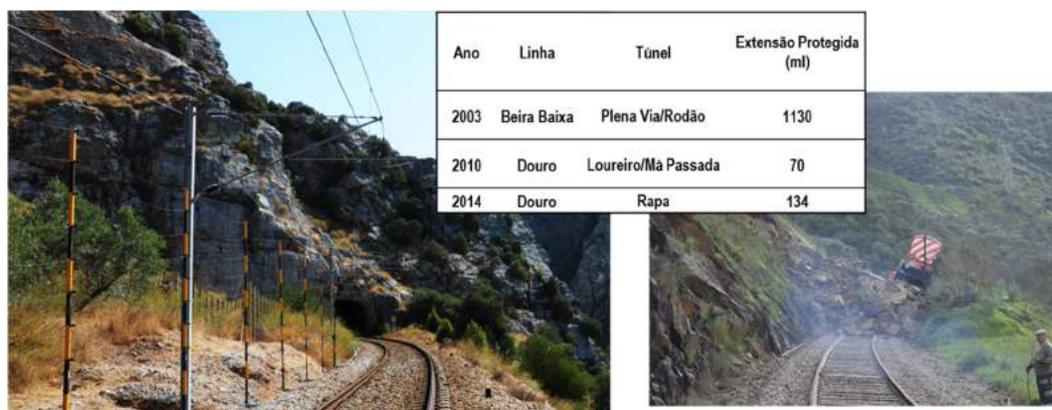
Monitorização de Escavações: Sistema de deteção da queda de blocos instalado em diversas linhas férreas.
